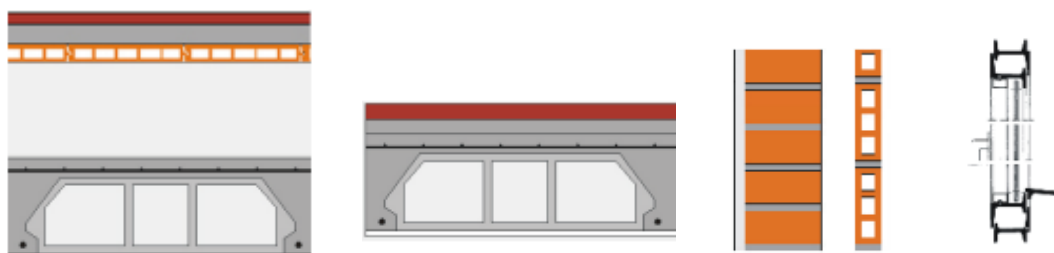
Detalles constructivos Cubierta, Forjados, Fachada, Carpintería. Fuente TABULA [108]
